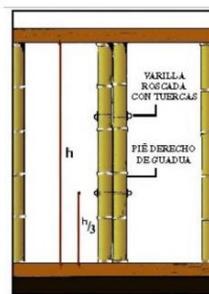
Unión entre muros en el mismo plano con pie derechos de guadua
